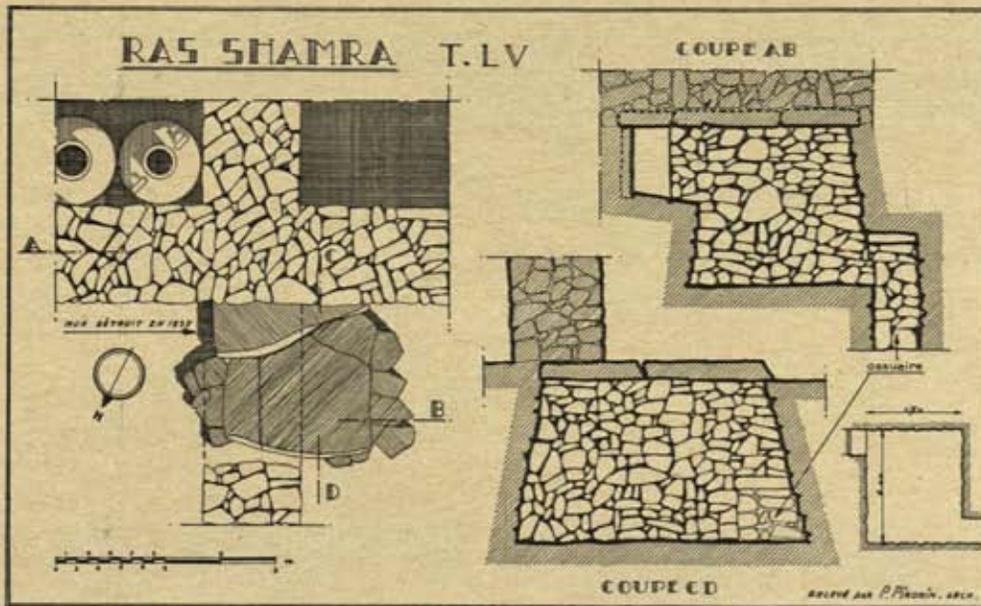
Plan et coupes du caveau LV. Relevé par P. Pironin.
